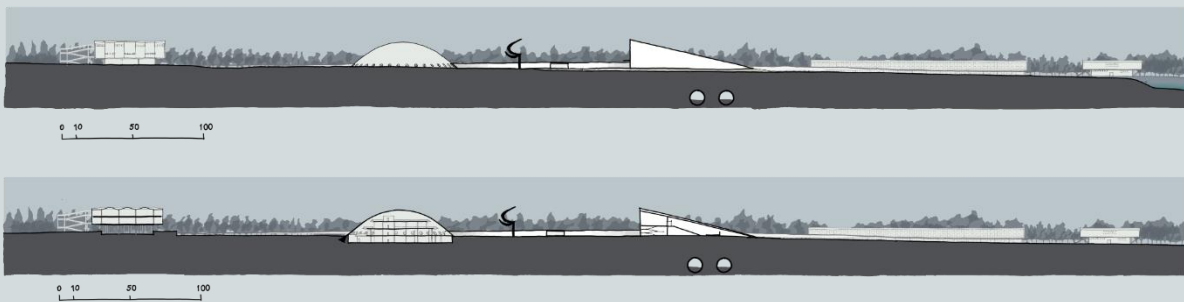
Implantação – 2000 – Versão 04 – desenho nosso.
